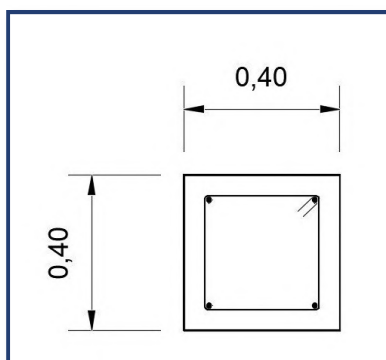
Sección propuesta de las vigas de atado de 7 metros.
